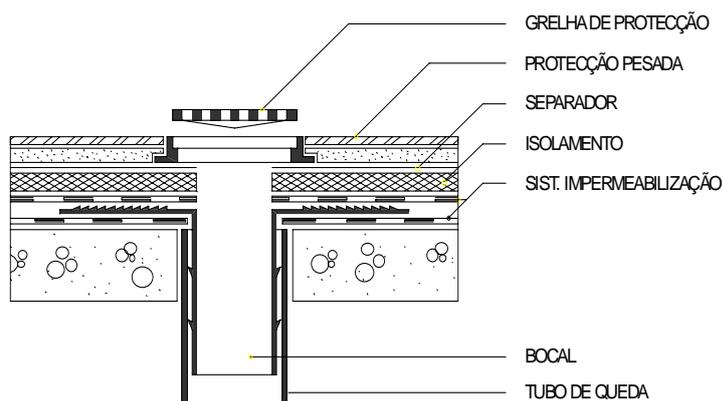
Ponto singular na caracterização de tubos de queda: coberturas acessíveis com isolamento térmico [Fonte: <http://www.imperialum.com> (Consult. 4 de Abril de 2007)]
